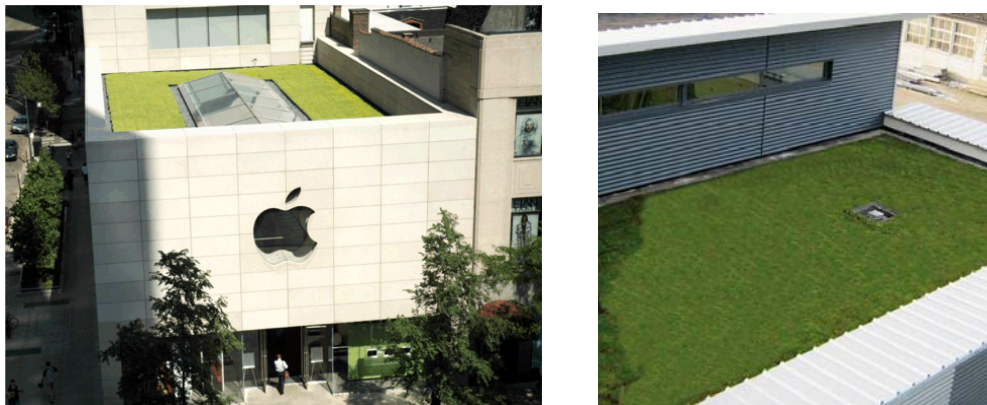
Cubierta ajardinada. (Fuente: <http://www.greenroofs.com> y <http://www.derbigum.es>)
